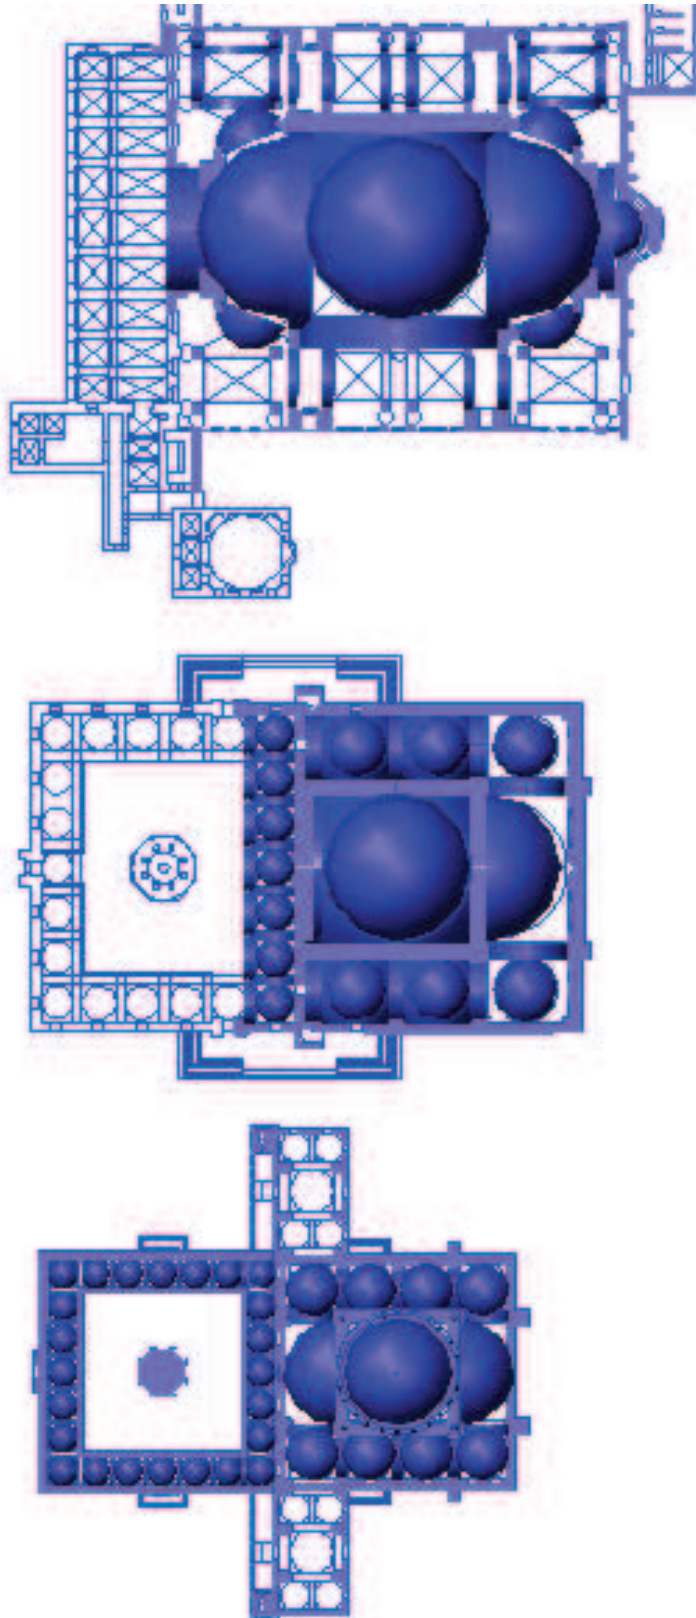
Vista en planta (misma escala y de arriba abajo) de Santa Sofía, Fatih camii y Bayaceto II. (Construcción 3D del autor)
